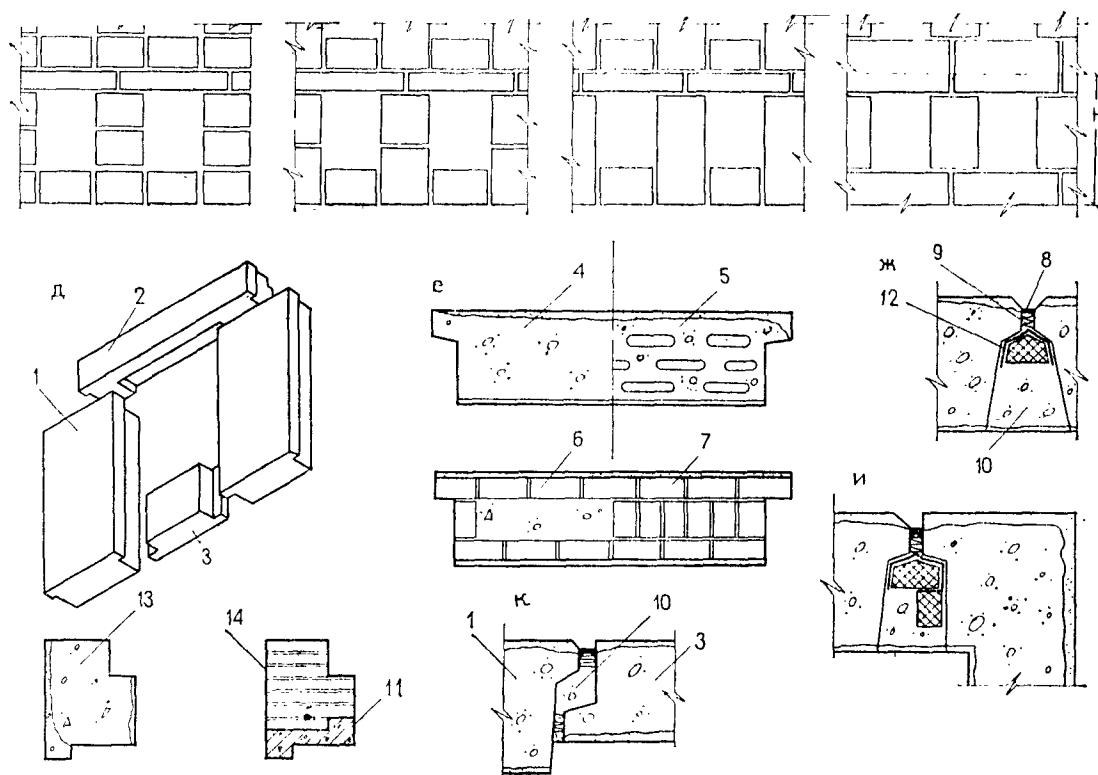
Крупноблочные стены. Схемы разрезов наружной стены на блоки: основные типы блоков и их вертикальных стыков
